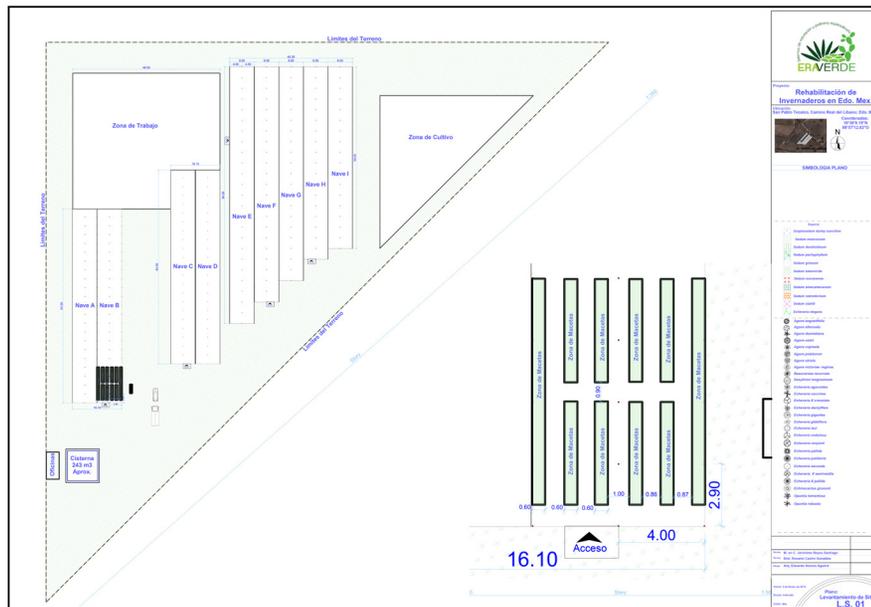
Plano de levantamiento de sitio de vivero de Totolcingo. Elaborado por Arq. Eduardo Alonso
